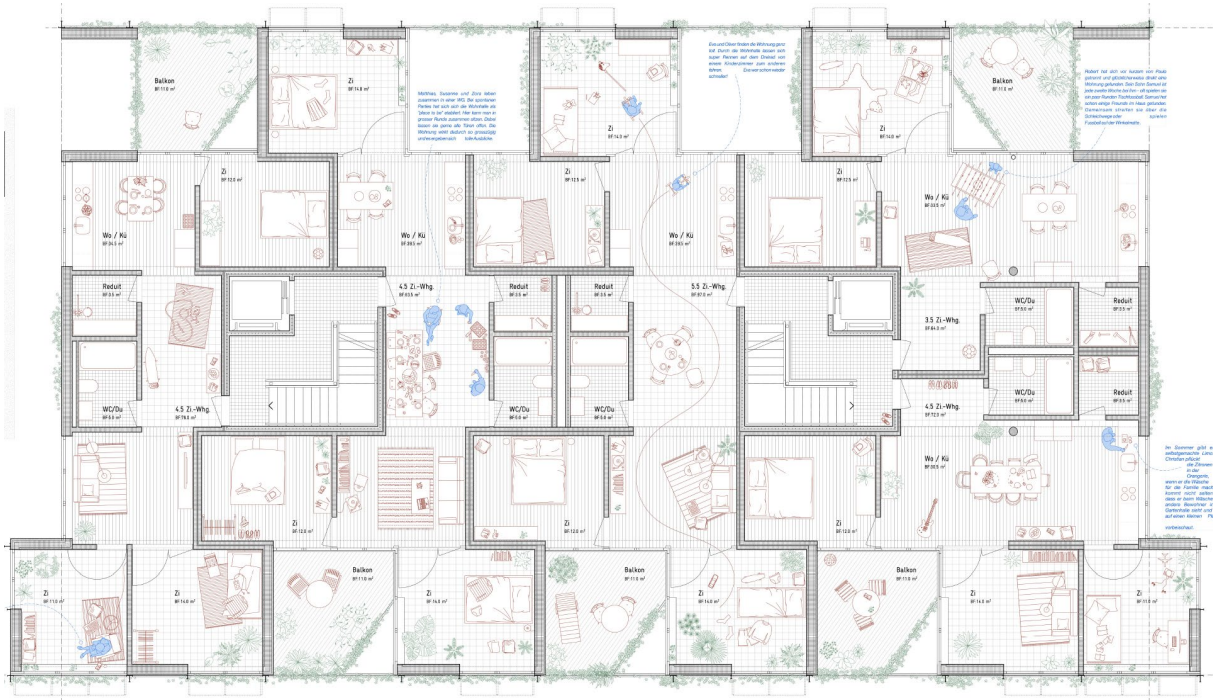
Grundriss Regelgeschoss, ohne Masstab
